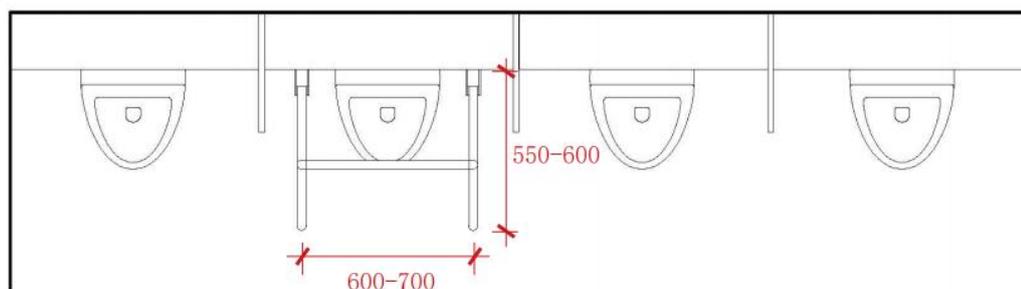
洗手盆区配置示意图（单位：mm）
